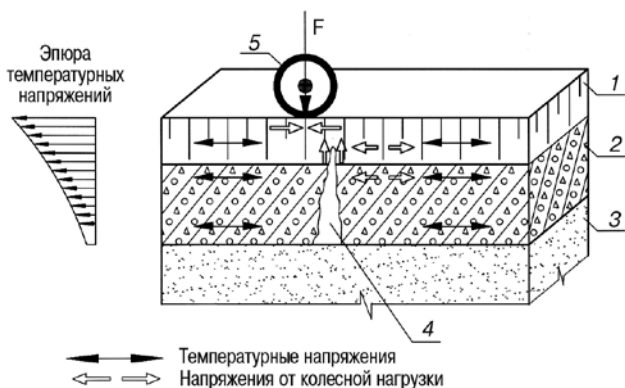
Механизм образования отраженной трещины: 1 – асфальтобетонное покрытие; 2 – цементобетонное основание; 3 – подстилающий слой; 4 – трещина; 5 – колесная нагрузка
